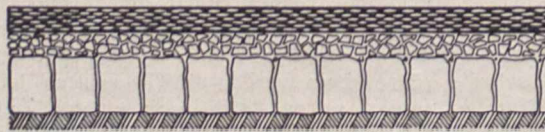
Einschichtiger Walzasphalt auf vorhandener Straße.
